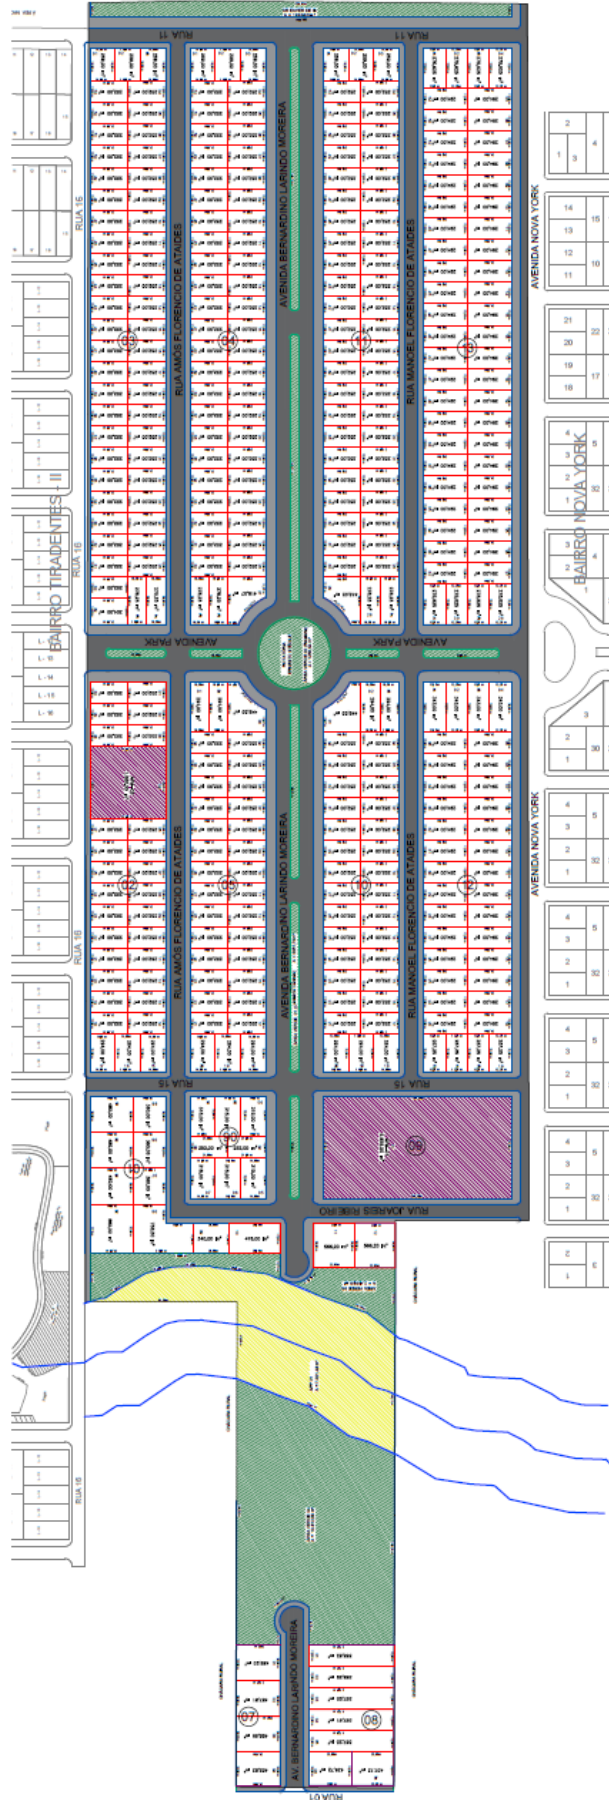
LOTEAMENTO MIRANTE DO LAGO
